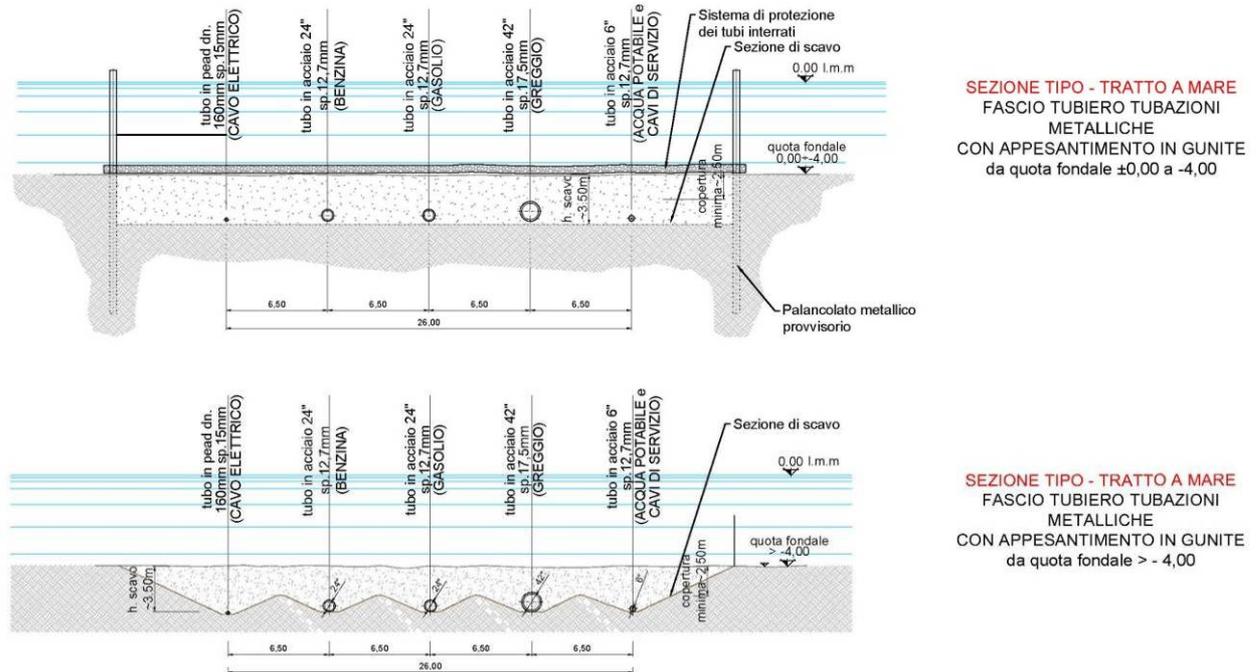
Fascio tubiero - tratto a mare: sezioni di posa.
